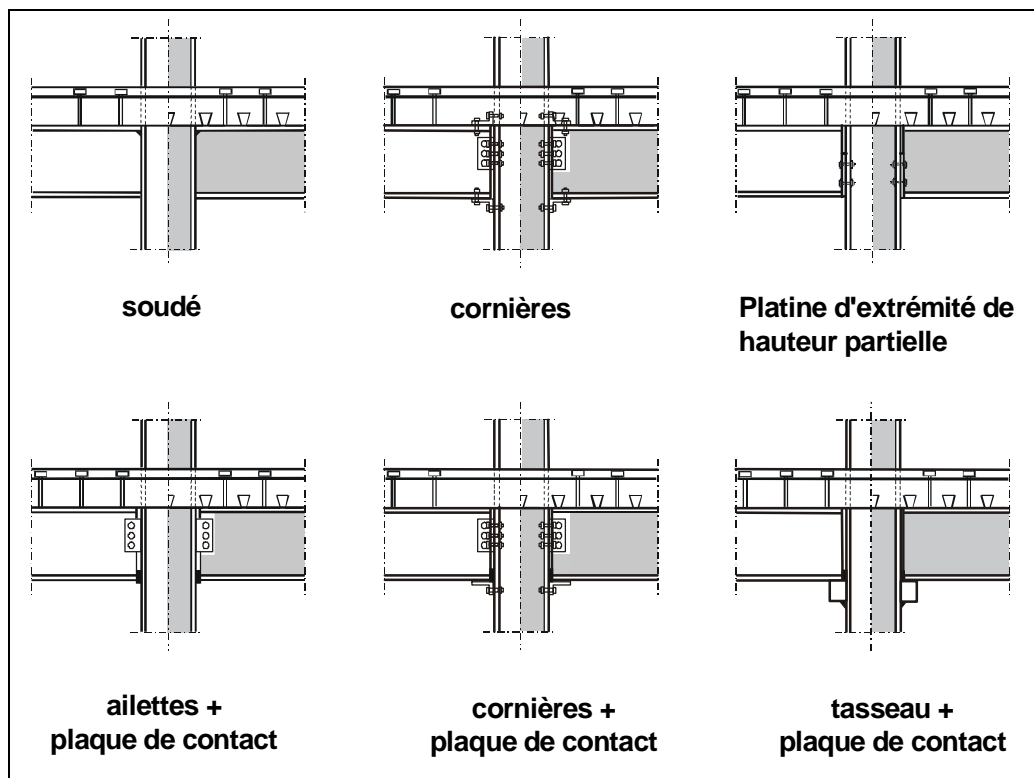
Types d'assemblages –Poteau à section en H et poutre à section en I [13]
